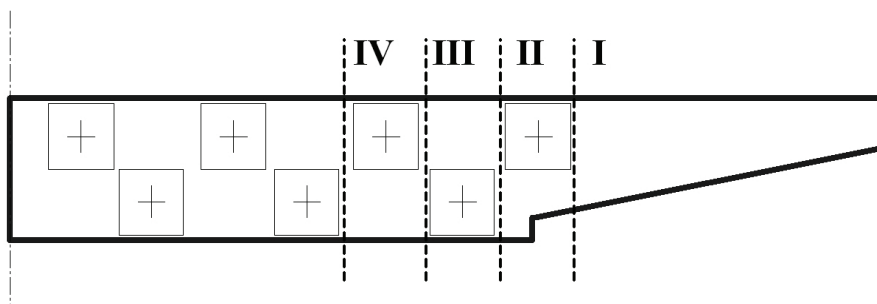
Ancrages en deux lignes – coupures verticales - dalle pleine
